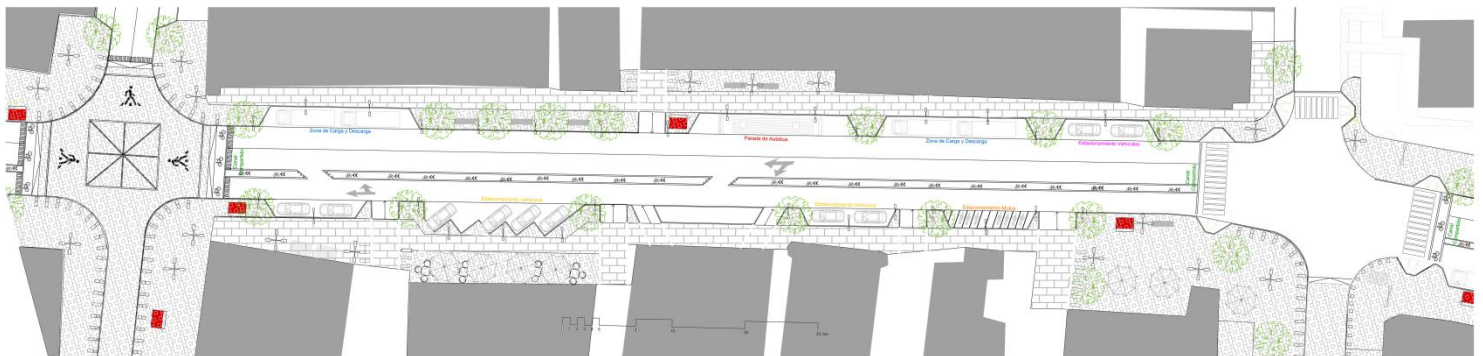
Prueba de diseño, Av. Francisco Solano López entre Av. Los Jabillos y Calle San Gerónimo
